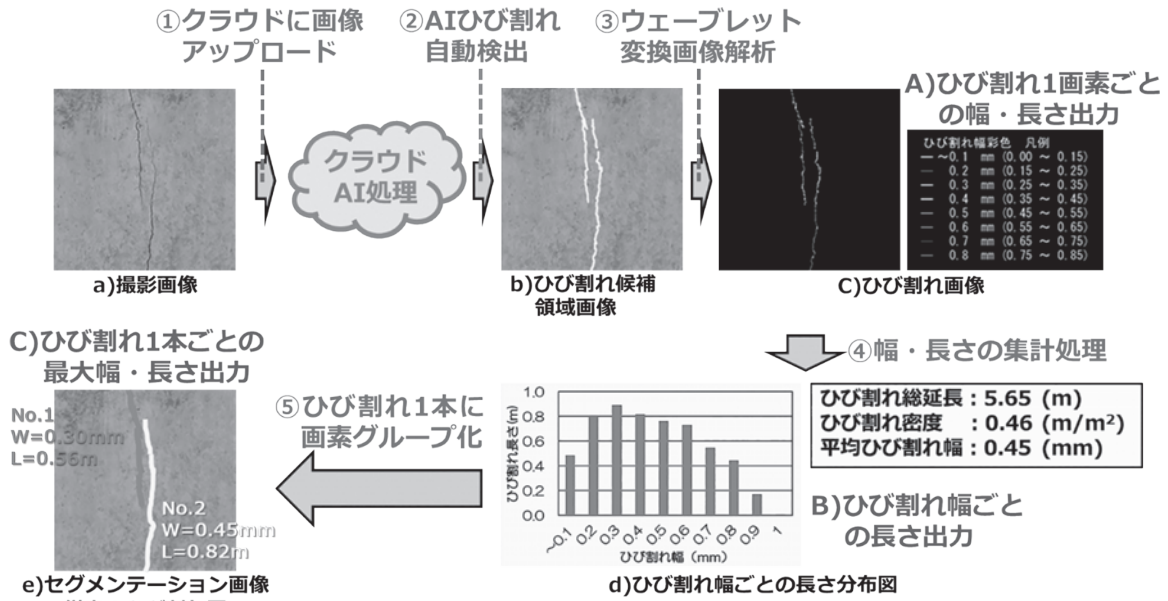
本技術によるコンクリートのひび割れ画像解析の処理手順¹⁾
